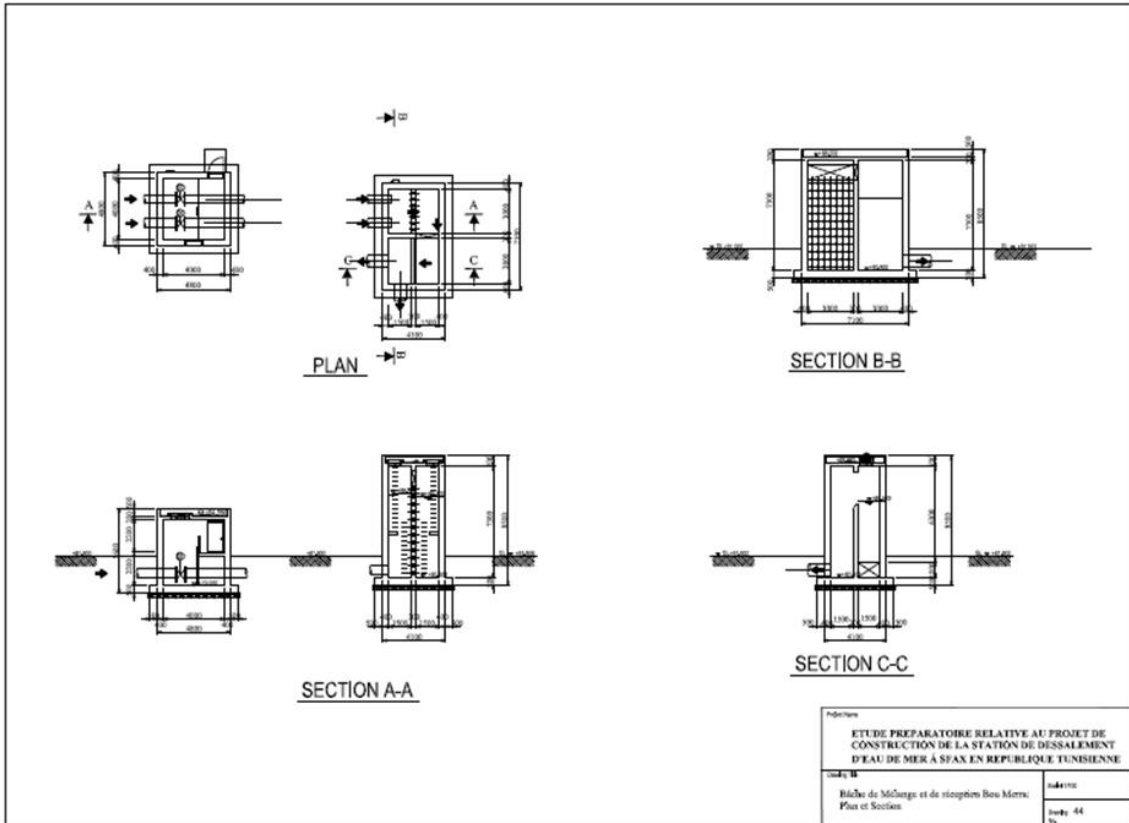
Bâche de mélange Bou Merra, plans et sections
